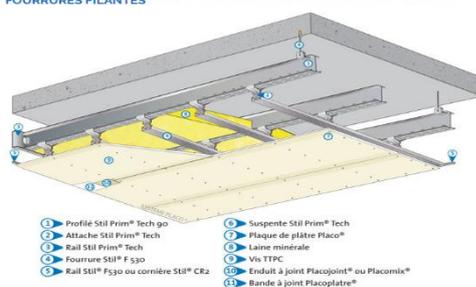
détail d'un faux plafond/source : système stil prim® tech pour plafonds longue portée
